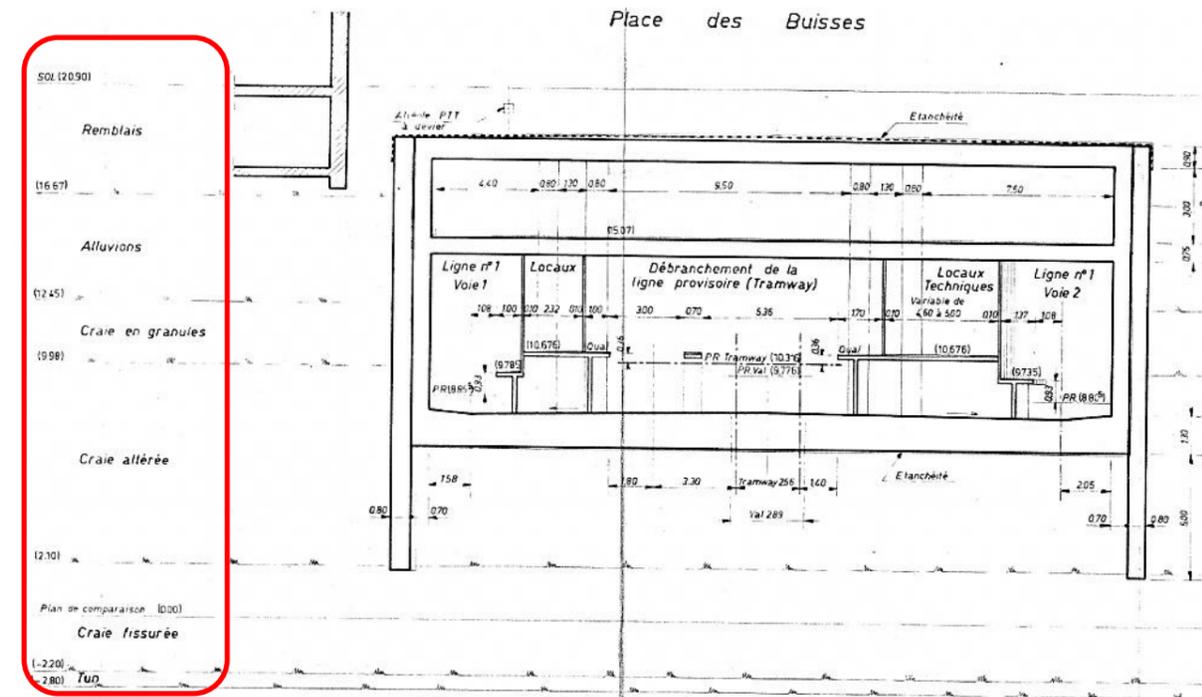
Coupe des lignes 1 & 2 du métro Place des Buisses et Place de la Gare
